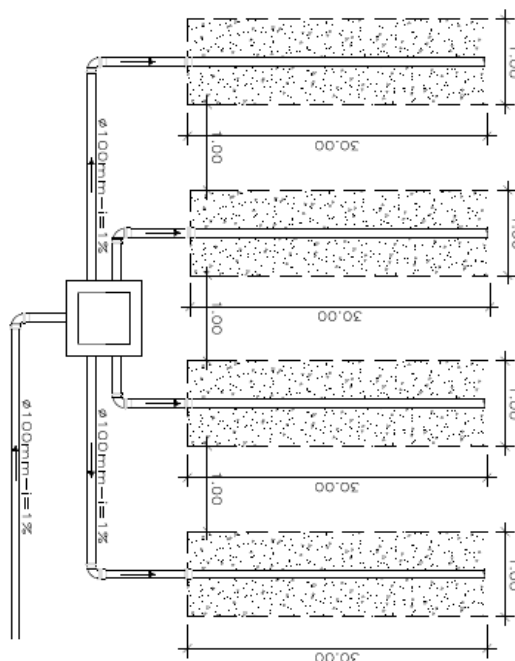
Detalhe Valas de Infiltração – Planta Baixa.
